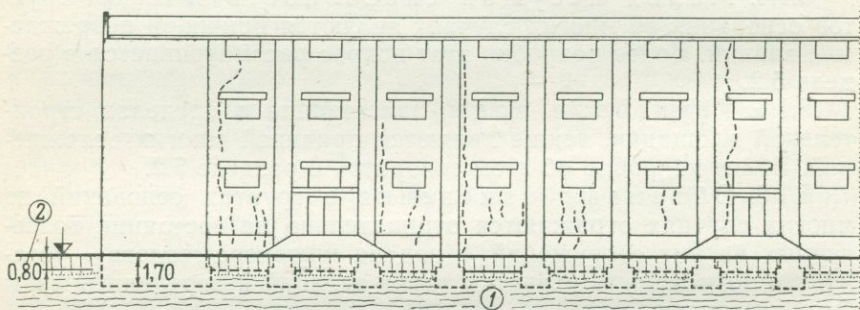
Промерзание в суровую зиму 1928—1929 гг. меловых мергелей в основании наружных стен здания, приведшее к нарушению и отрыву этих стен от более глубоко заложённых колонн.
